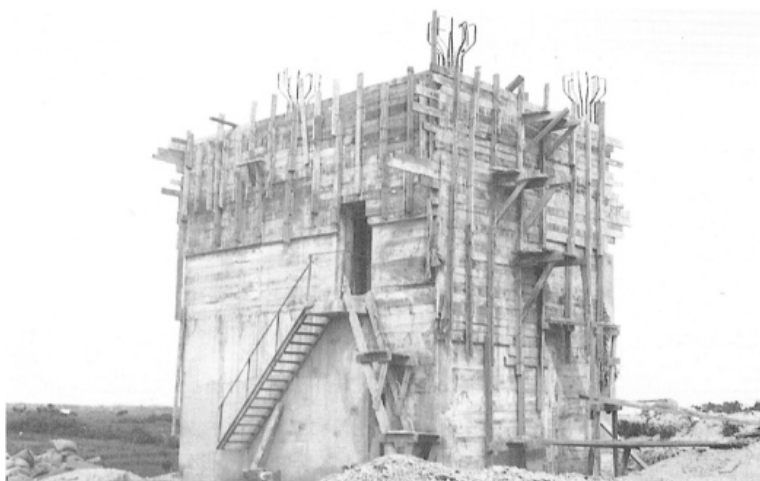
Construcción del P.C. de la Batería de Punta Candor. 23 de mayo de 1943. Vista lateral y de acceso.
